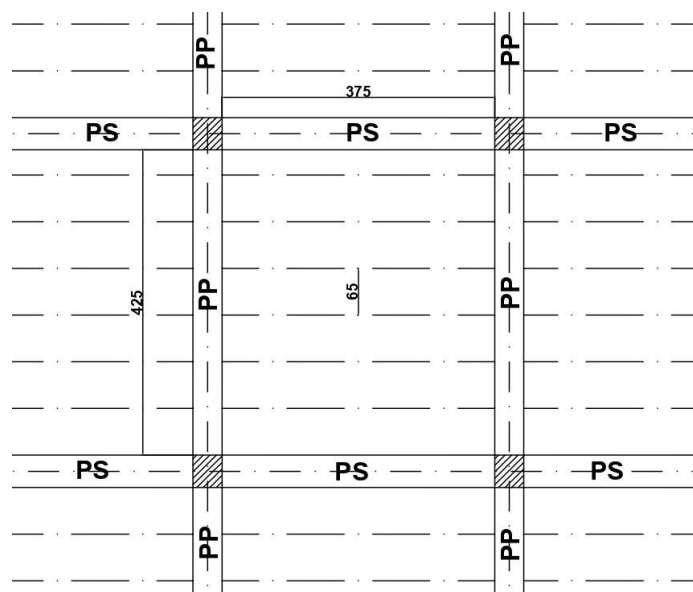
Plan de la position des poutres principale, secondaire et le sens des nervures
